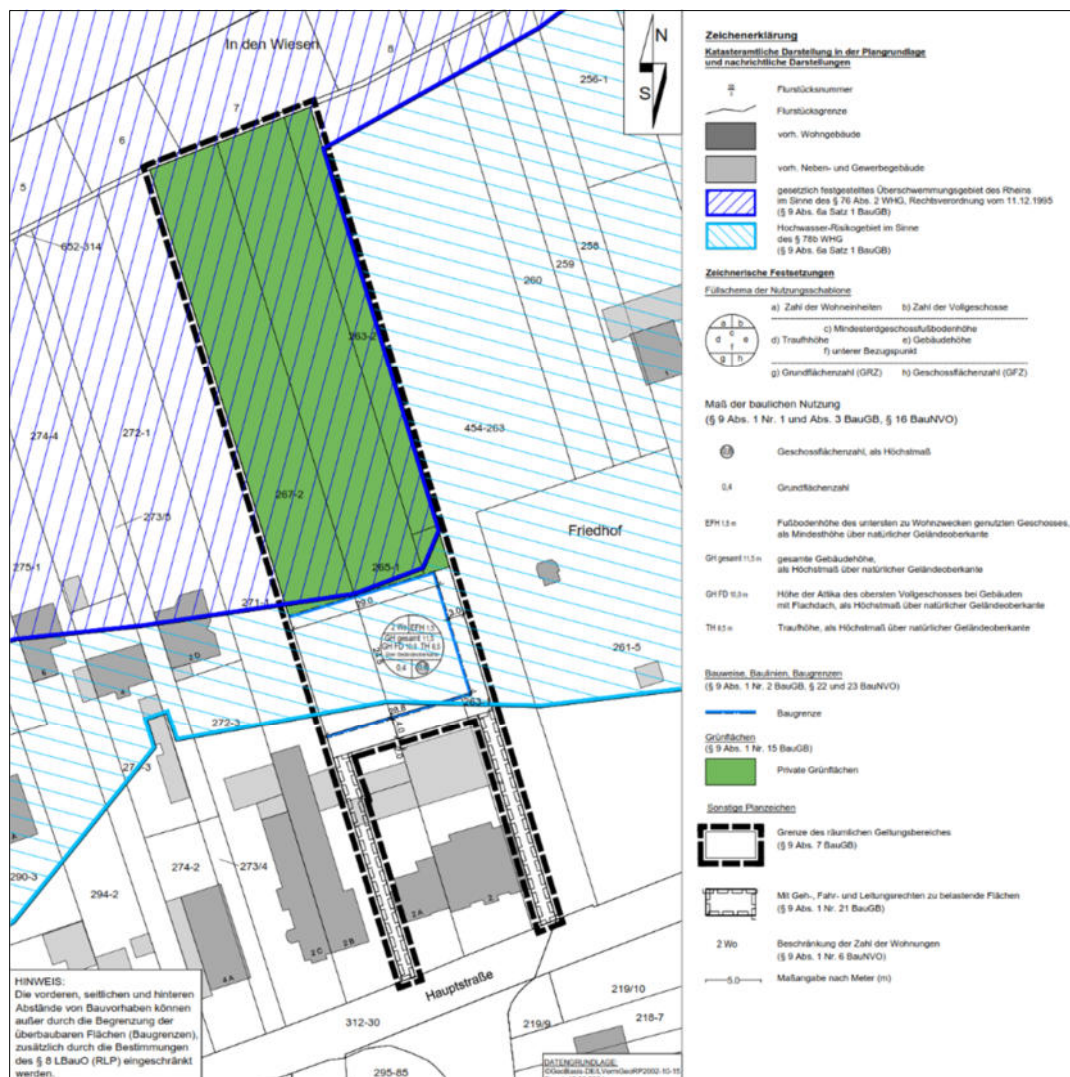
Entwurf der Planzeichnung der Einbeziehungssatzung, o.M. (Quelle: FWI Teamplan GmbH).
